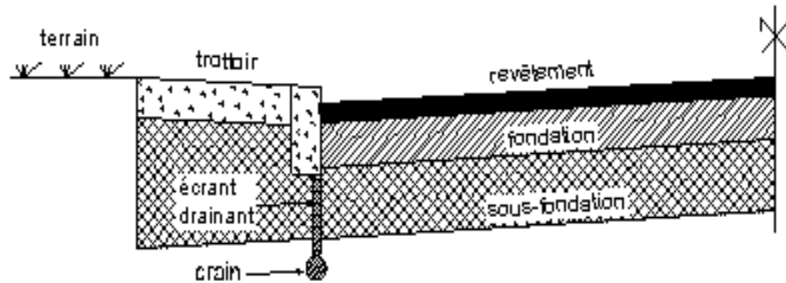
Drainage par écran drainant vertical en rive de chaussée
